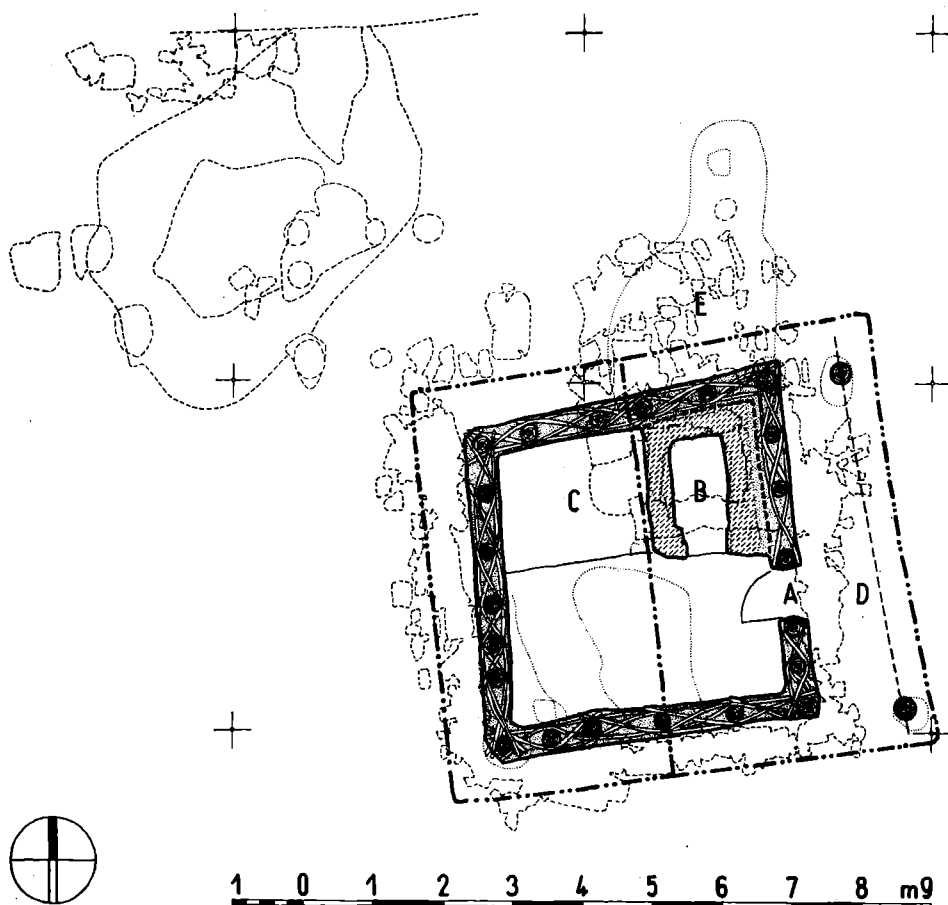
Rekonstrukce půdorysu usedlosti II (kresba autor).
